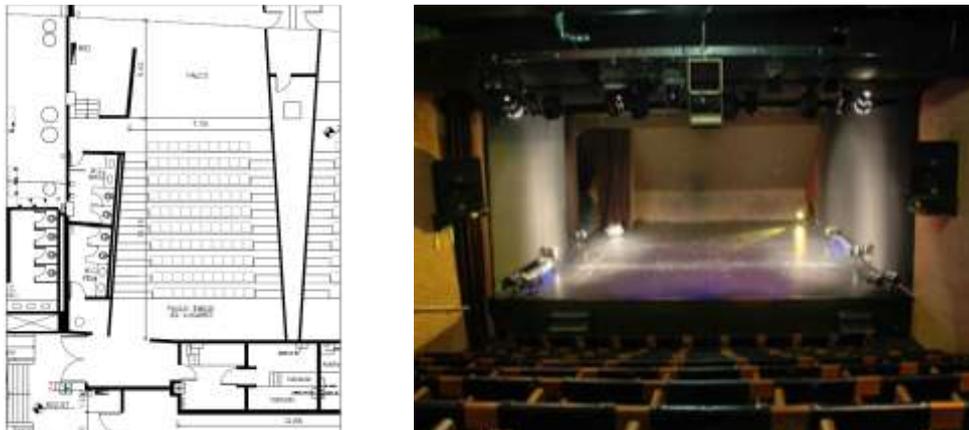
e 56: Planta e foto do Espaço Cênico Ademar Guerra (respectivamente)
